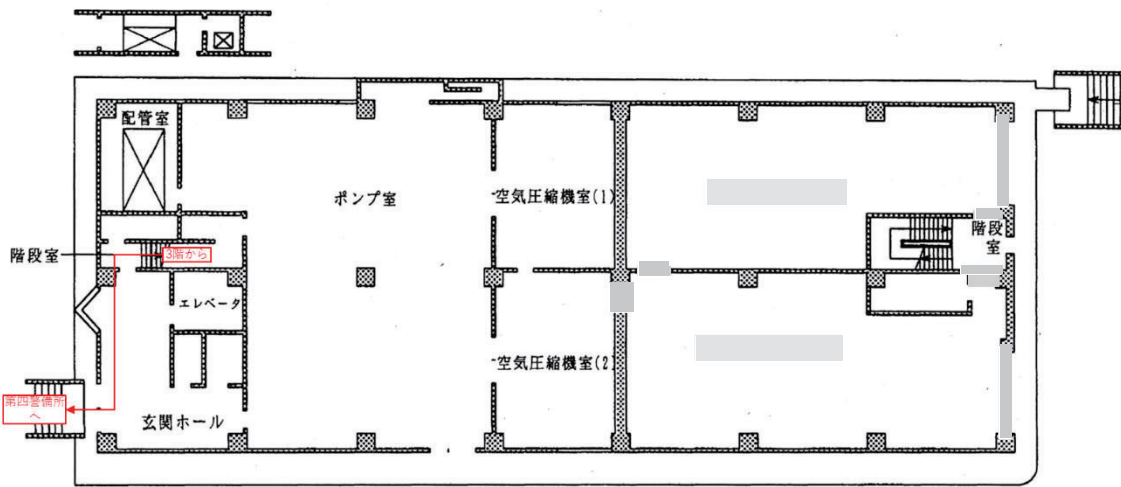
(2) 移動経路 (ユーティリティ施設 地上1F 平面図)
